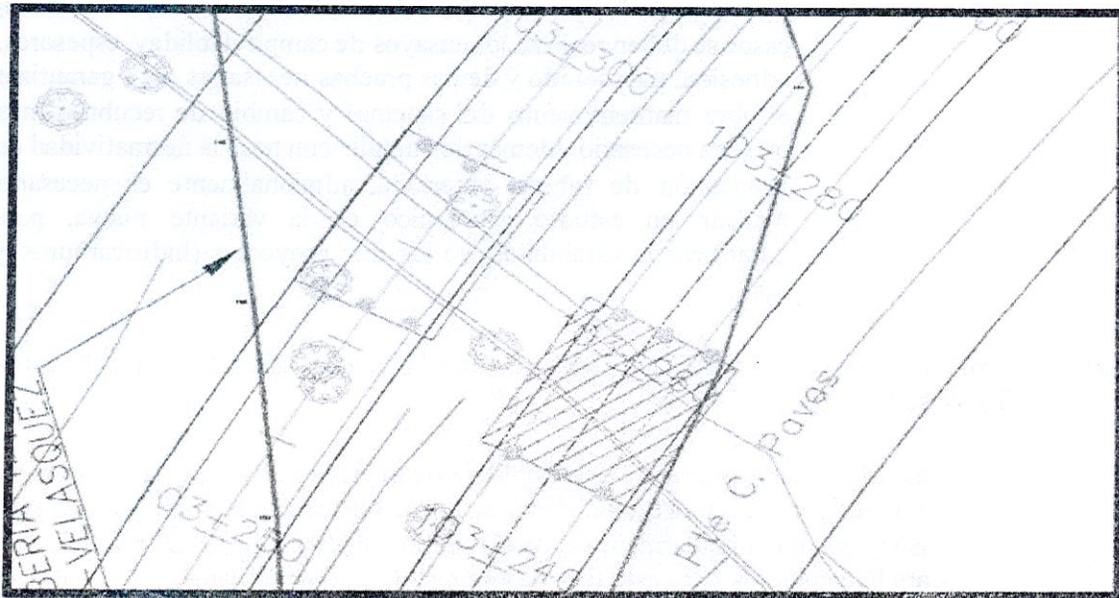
Acercamientos críticos con estructuras viales (Puentes) e infraestructura petrolera
